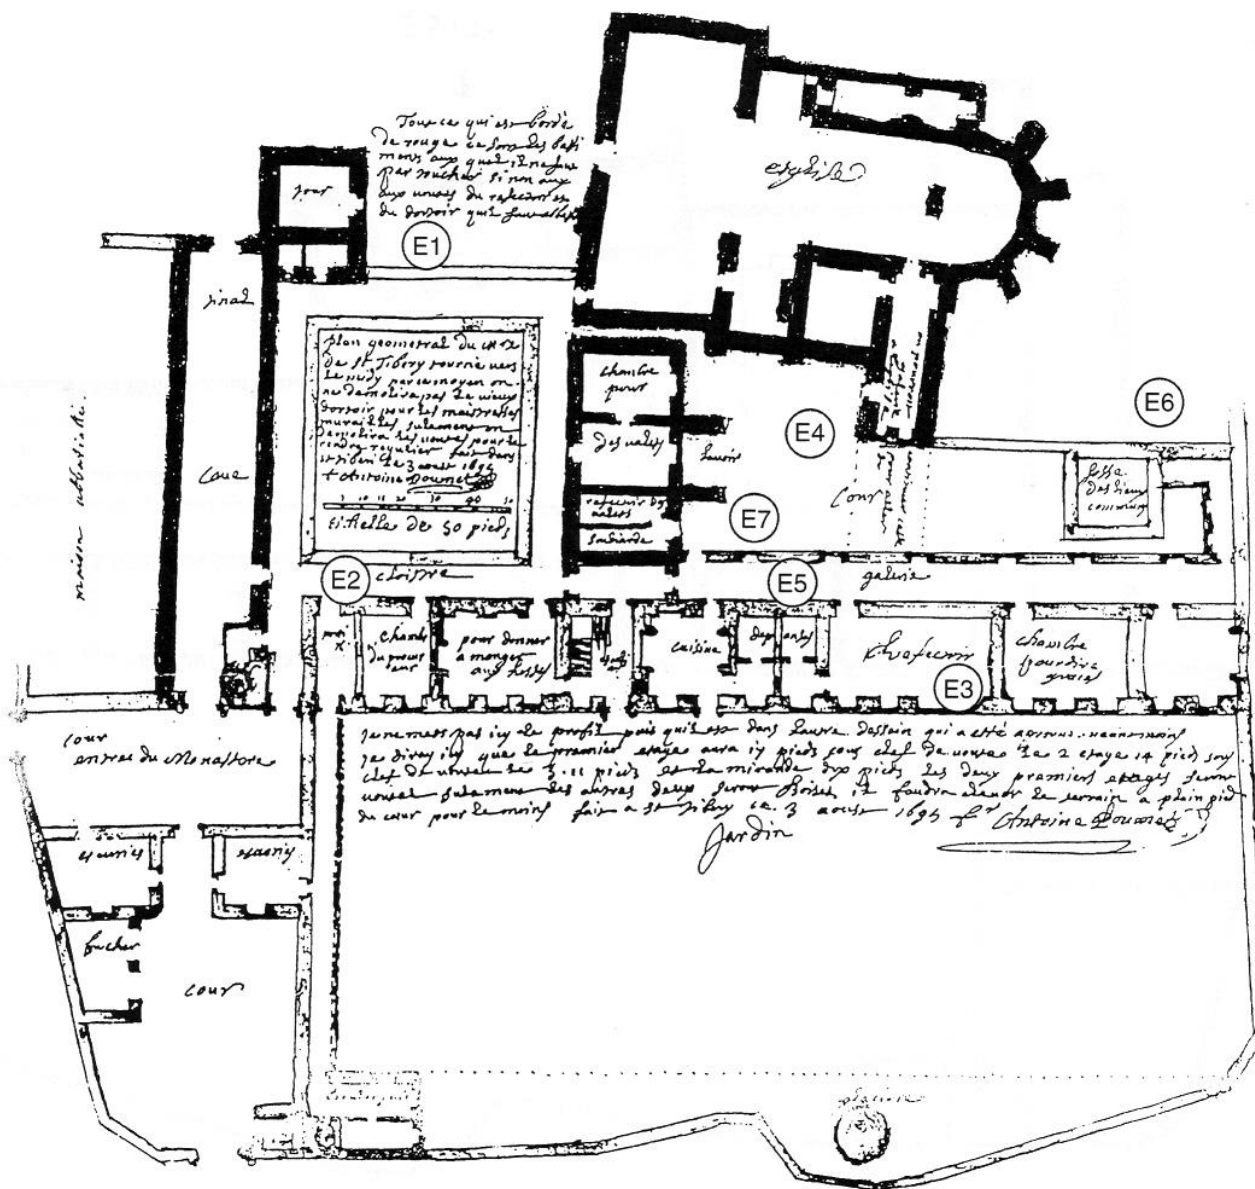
Plan E. Le projet de 1695 : le rez-de-chaussée (appelé « premier étage »)
